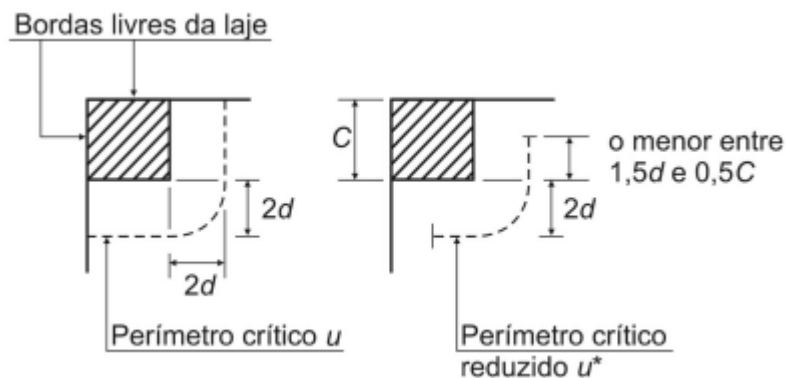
DEFINIÇÃO DO PERÍMETRO CRÍTICO EM PILARES DE CANTO
